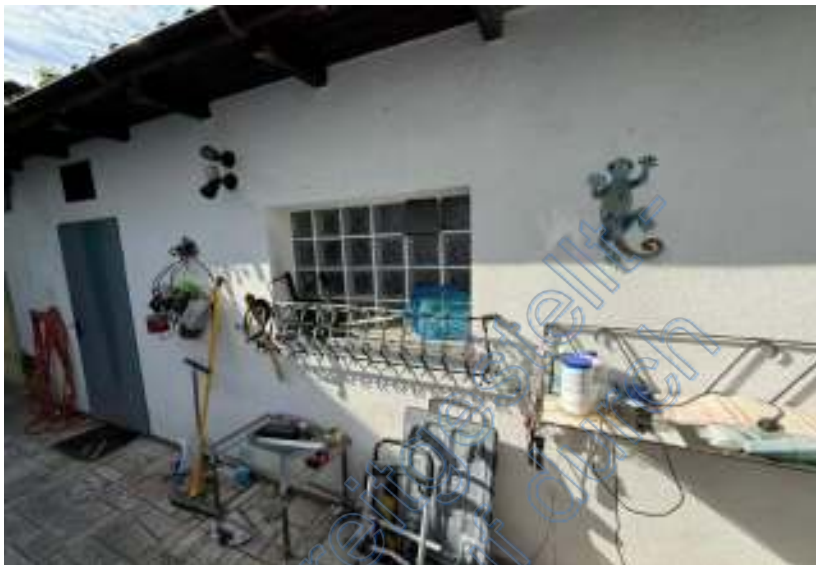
des SV: Nebengebäude (Garage/Werkstatt)
